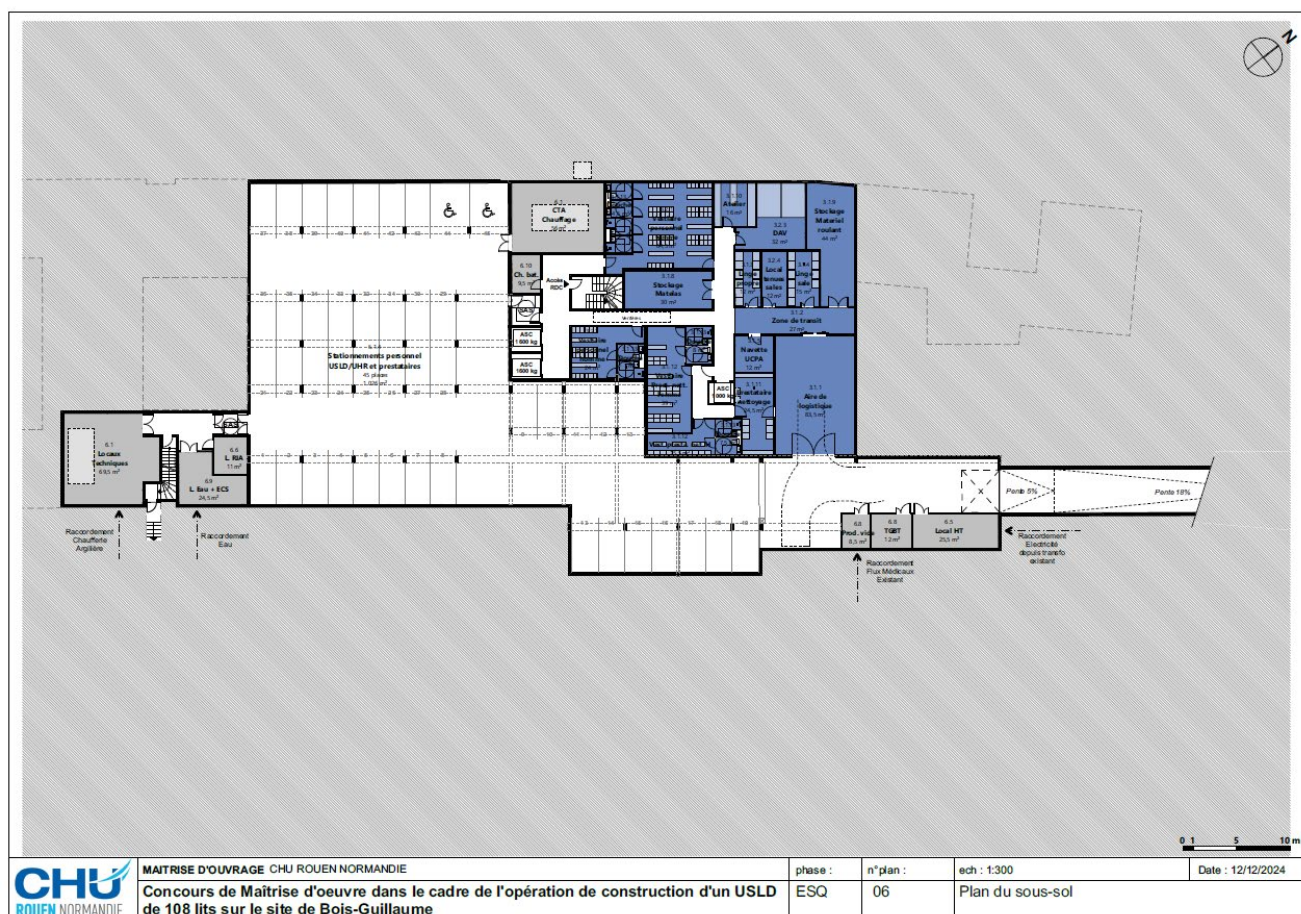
Plan d'aménagement du sous-sol (source : Client, référence : Phase ESQ, plan n°6, Plan du sous-sol, plan du 12.12.2024)
